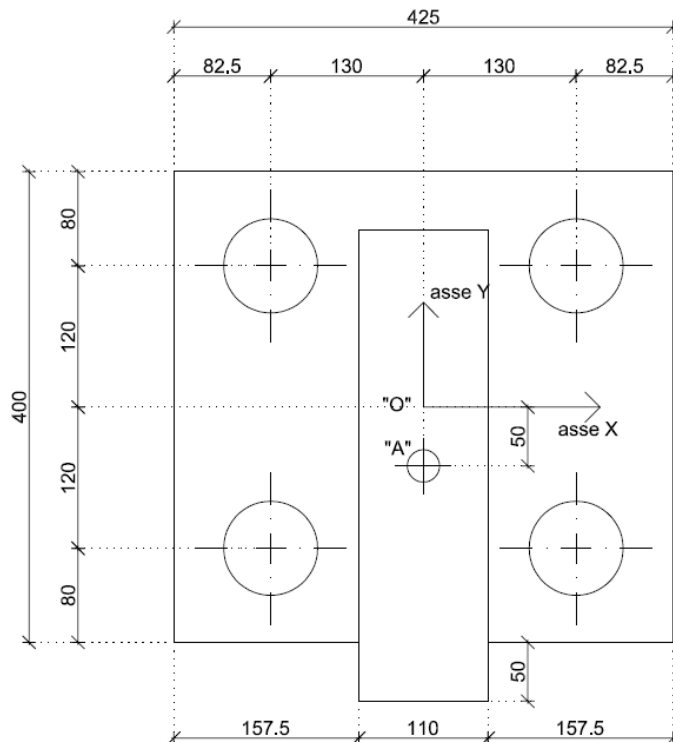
schema tipo calcolo platea/pali di fondazione P.E.A
